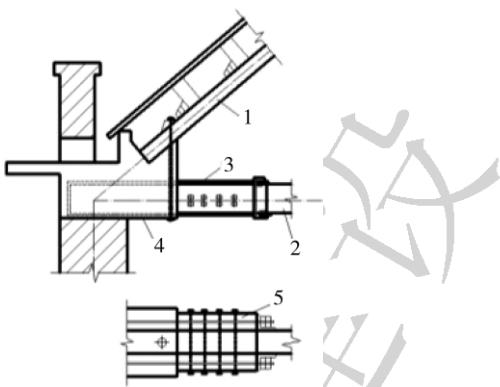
支座节点腐朽用钢筋混凝土加固接头
